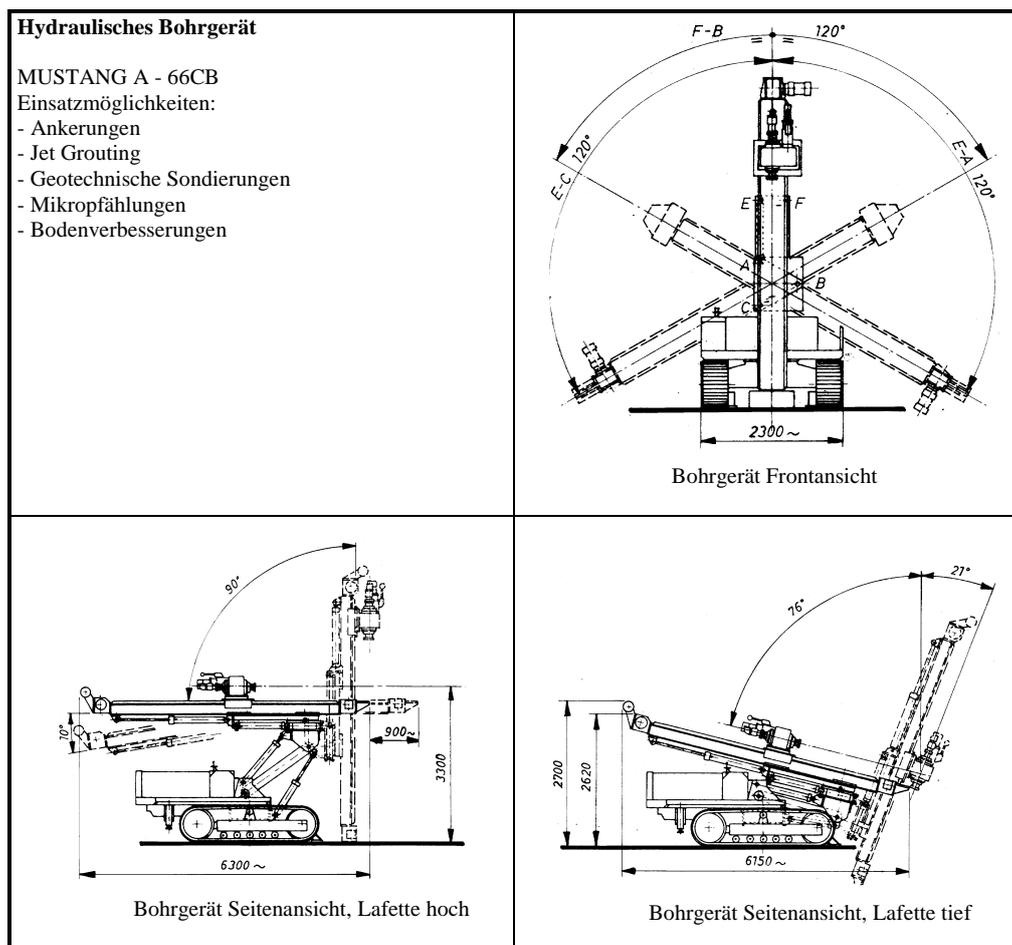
Hydraulisches Bohrgerät mit Verlängerungsmagazin [1]
